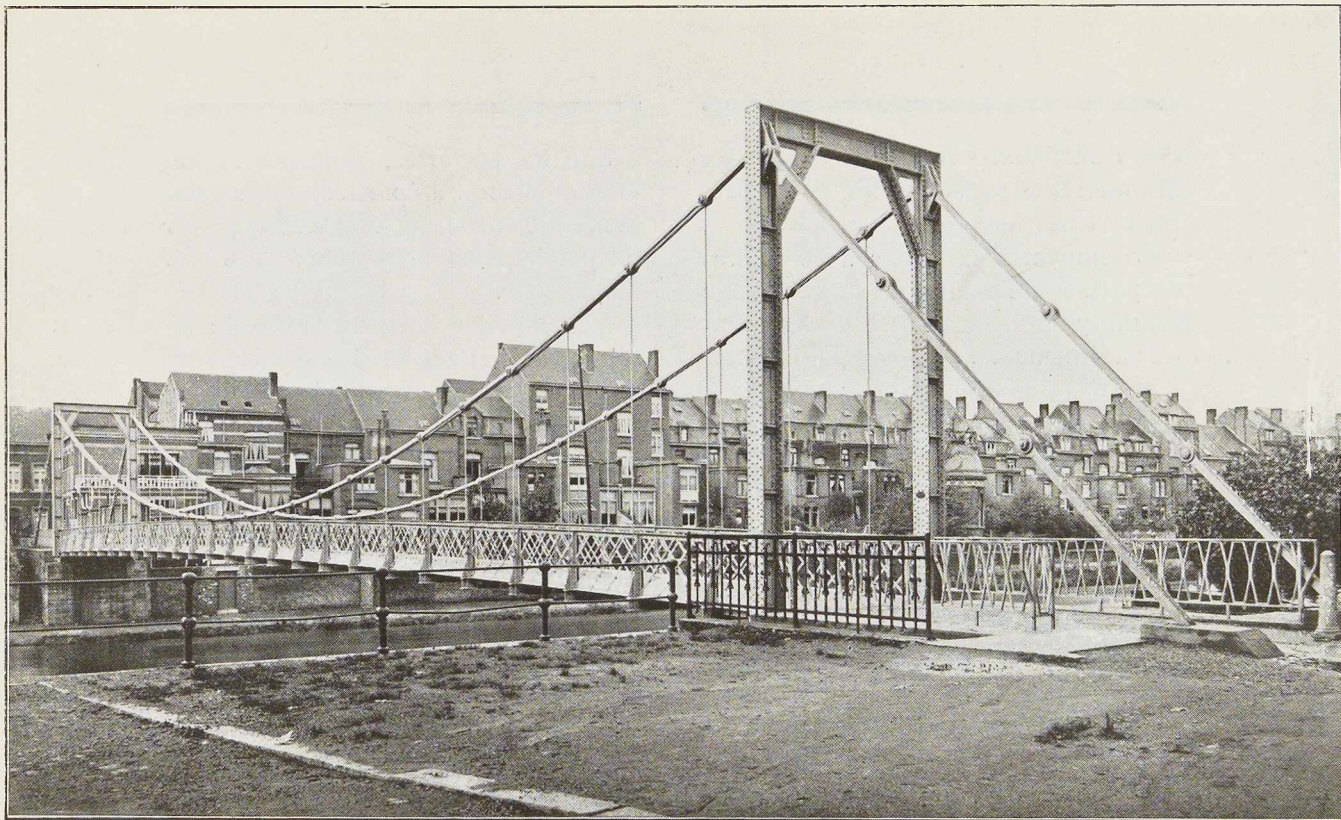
Passerelle métallique sur la Sambre à Namur, construite par la S. A. des Ateliers de Construction de Jambes-Namur.
